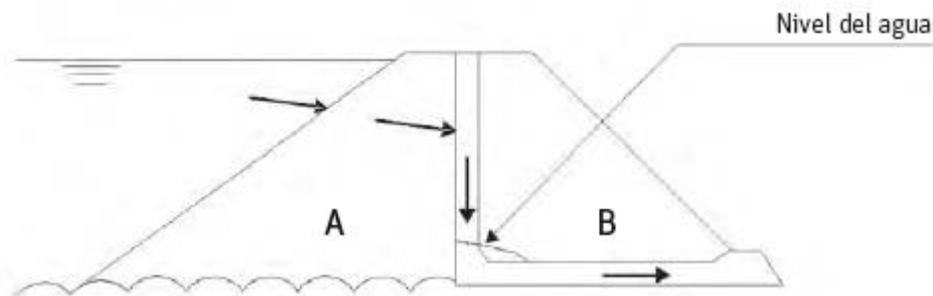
Sección tipo dren chimenea. Guía para el proyecto y construcción de balsas de tierra.
